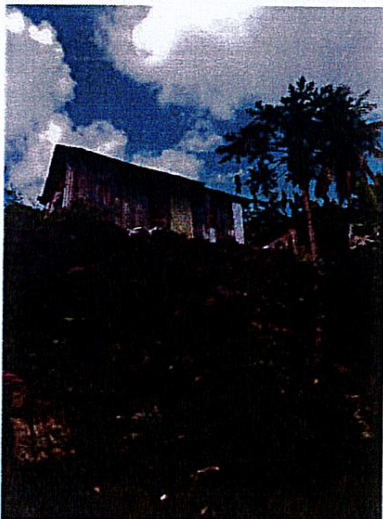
emplacement logement dangereux, risques de chute et blessures.
